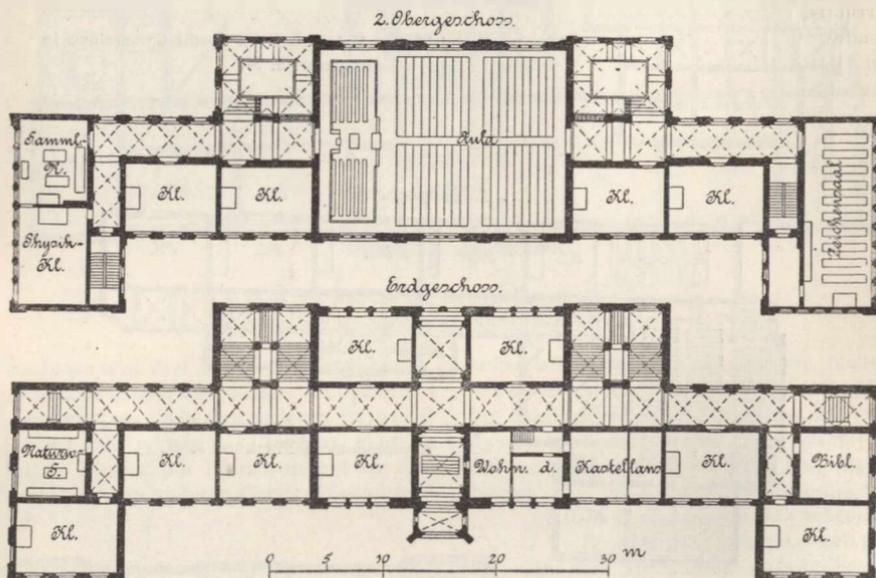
u. 34. Grundrisse des Prinz Heinrich-Gymnasiums in Schöneberg.
